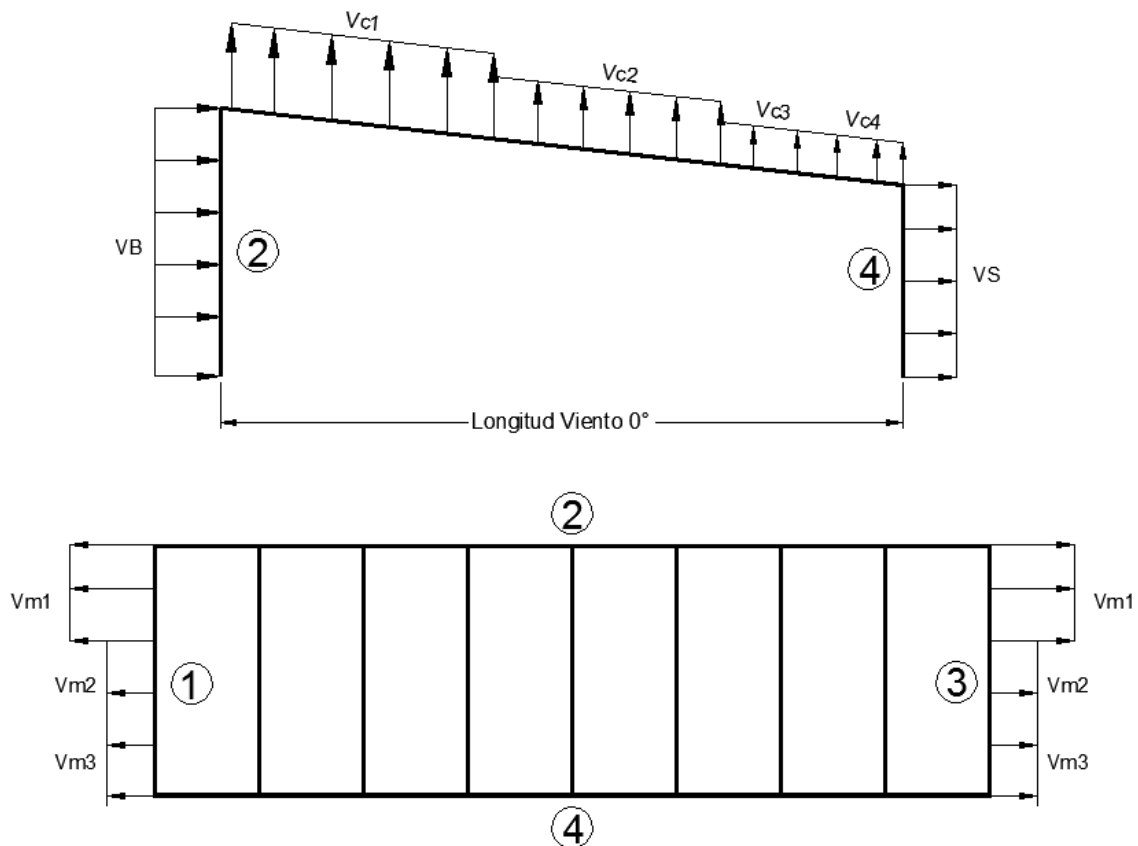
Planta y corte de distribución de presión en muros de viento a 0°.
